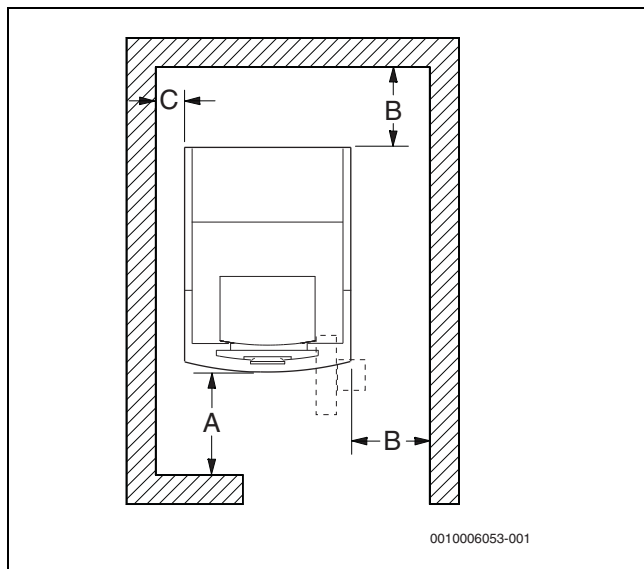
Distanze dalle pareti (vista dall'alto) nel locale di posa
